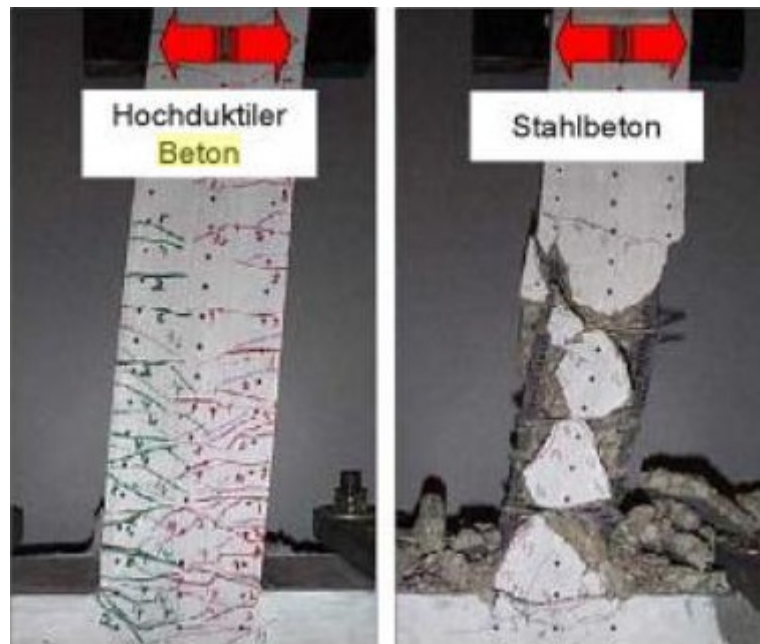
Vergleich Stahlbeton mit hochduktilen Beton [36]
